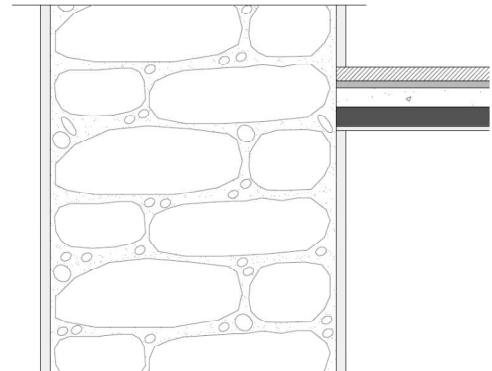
Fachada-Forjado (por revoltón). Zona este. Estado original.
